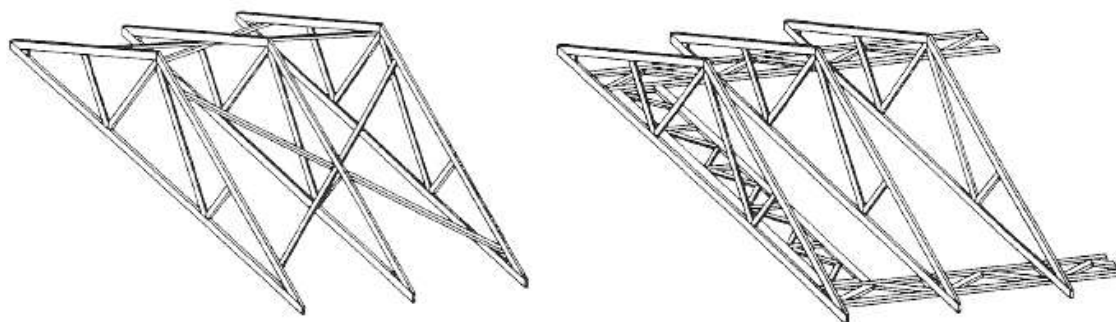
Contraventamento vertical e horizontal (Mesquita Madeiras, 2004)
